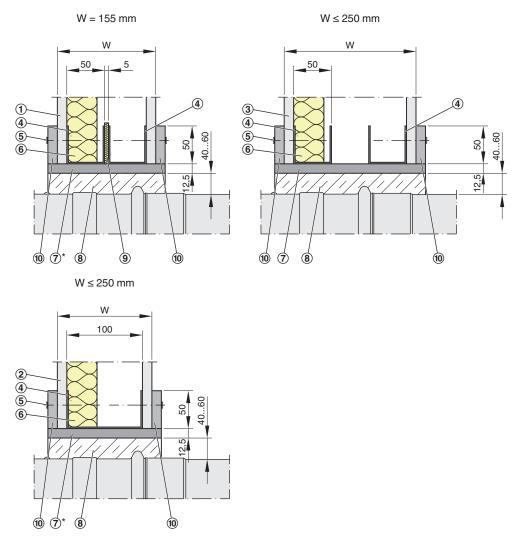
Nasseinbau in F30-Leichtbauwände mit W ≥ 155 mm
